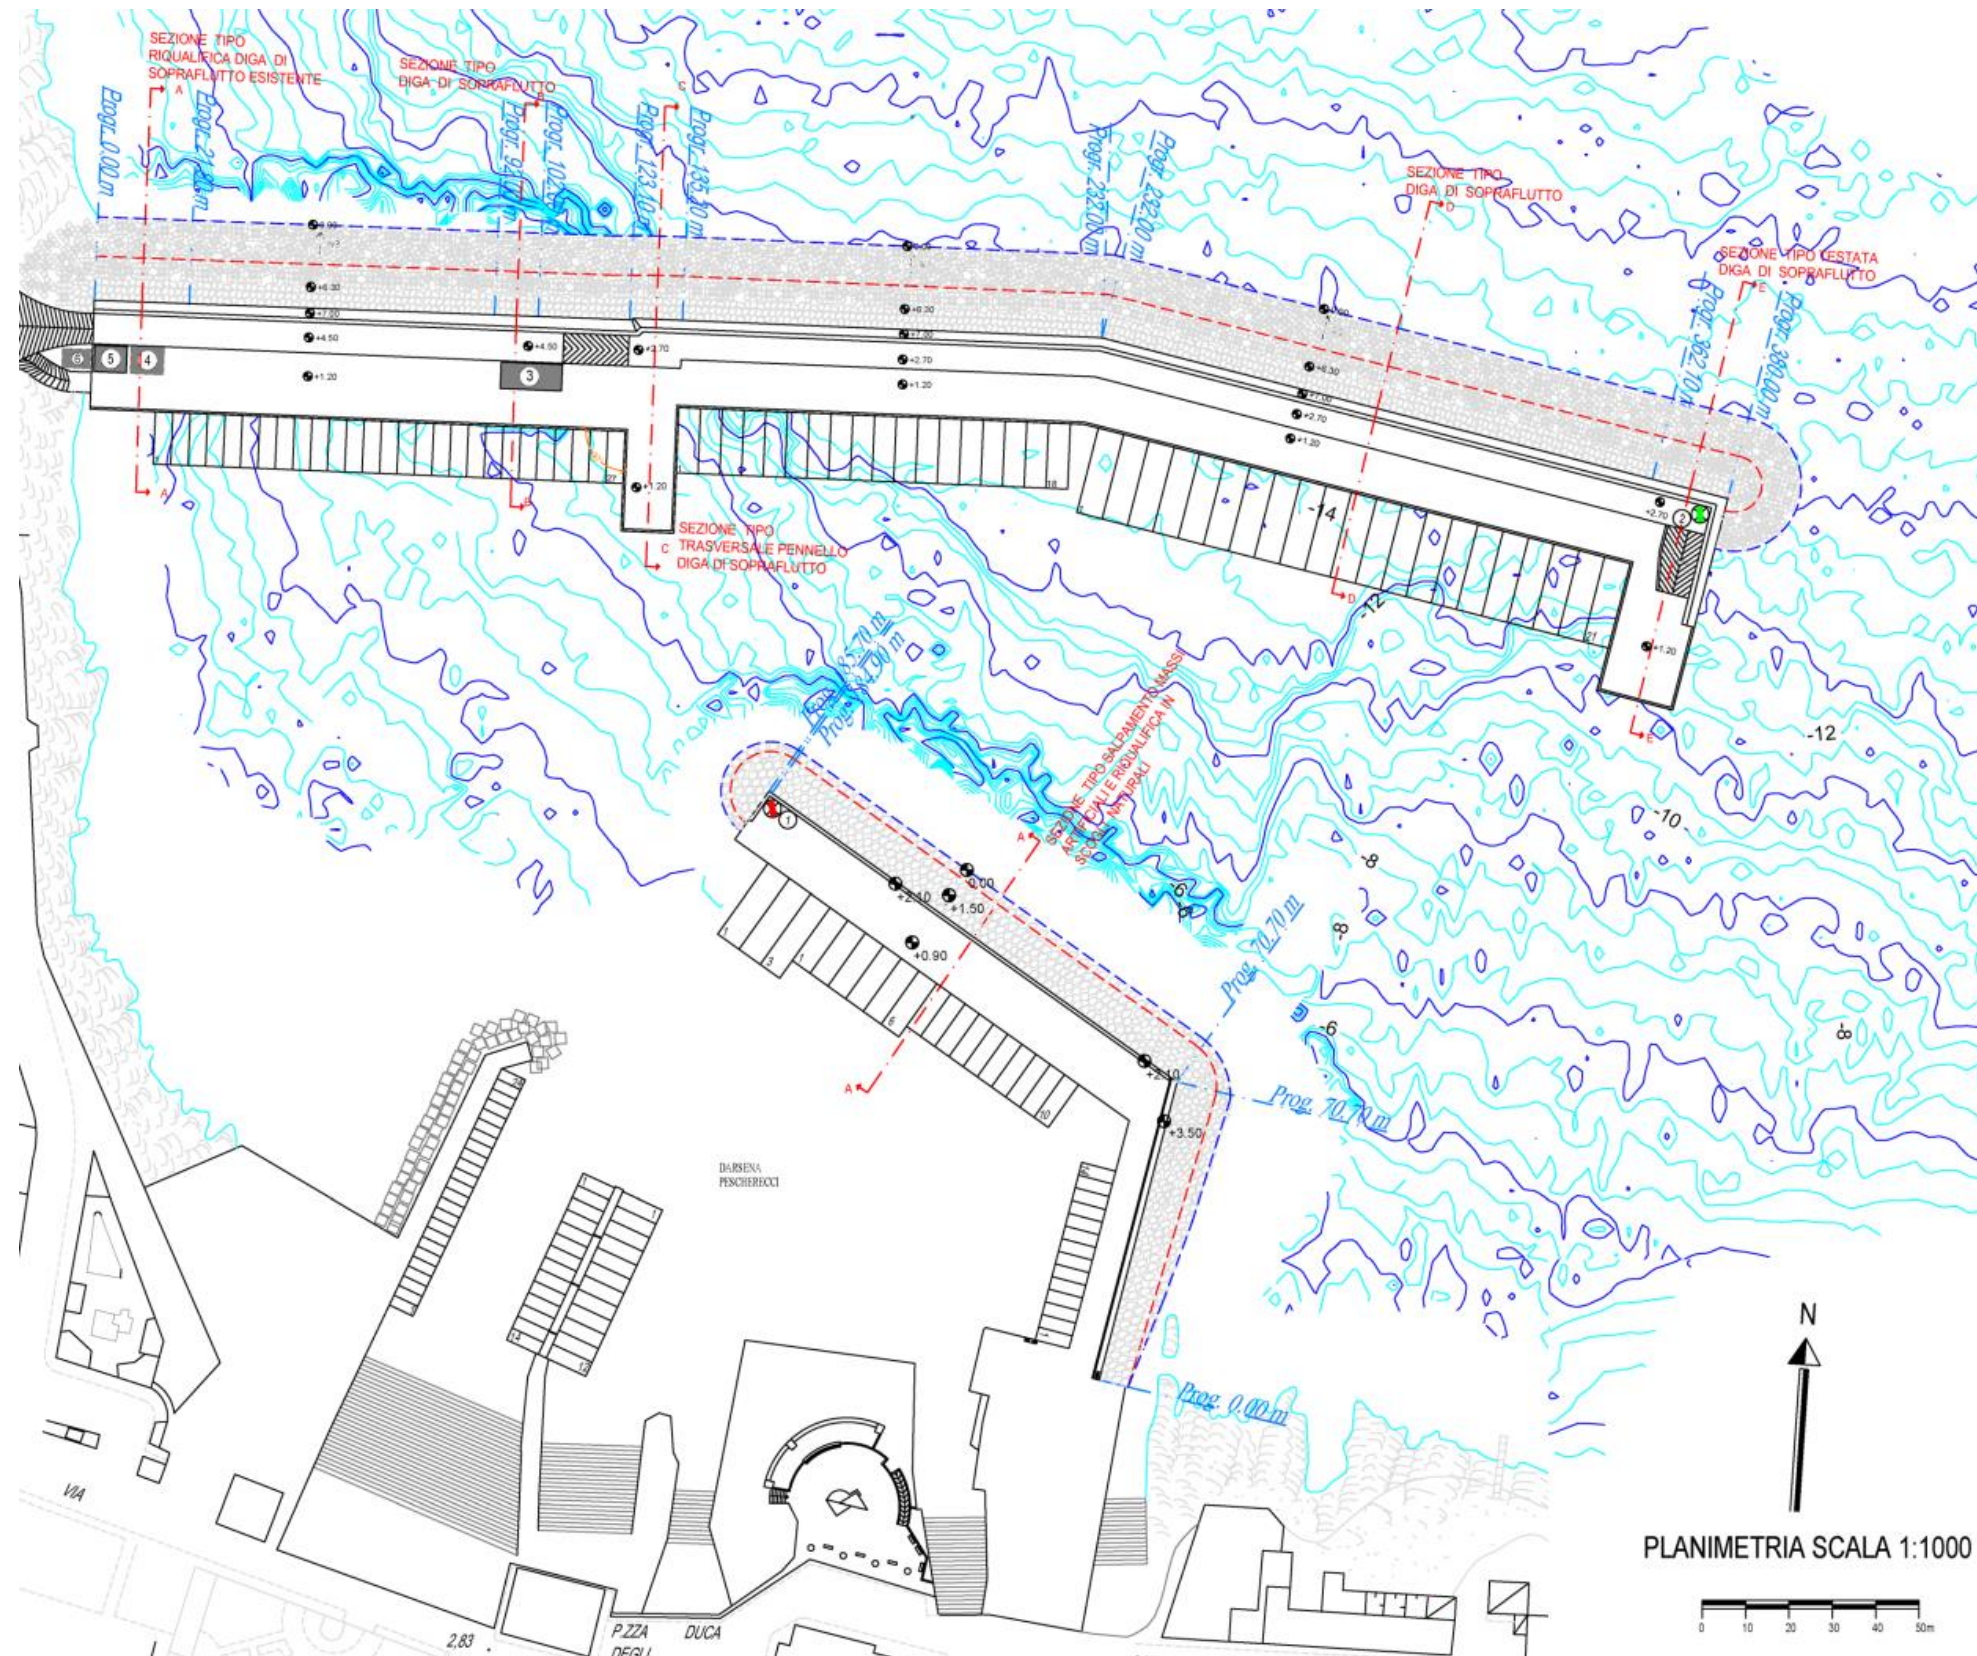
Progetto esecutivo delle nuove opere previste nel porto di Isola delle Femmine: Planimetria delle nuove opere.
